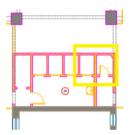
Ferro exposto em viga e lajes - segundo pavimento
